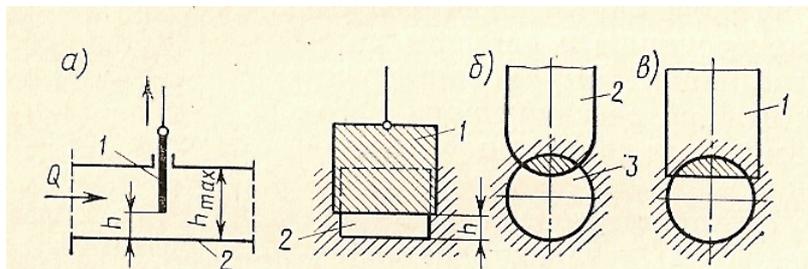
Конструкция прямоугольного (а) и круглого (б, в) шиберов
